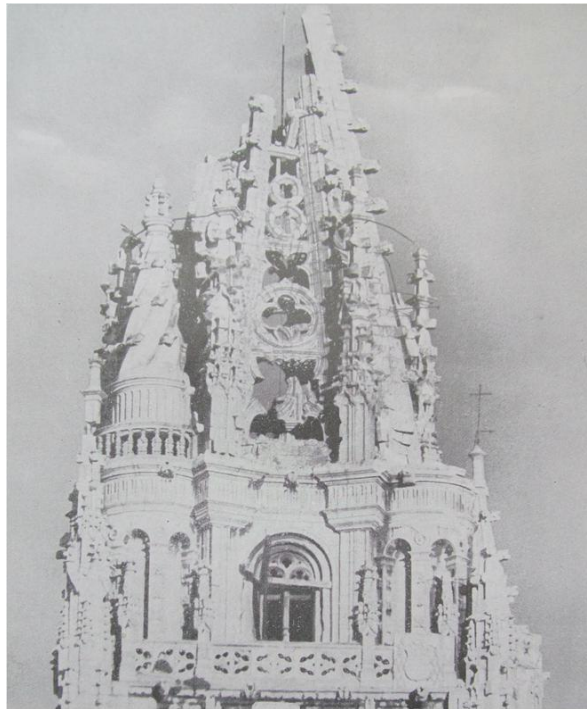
Estado de la torre de la catedral tras la contienda. Reconstrucción, n.º 21.
